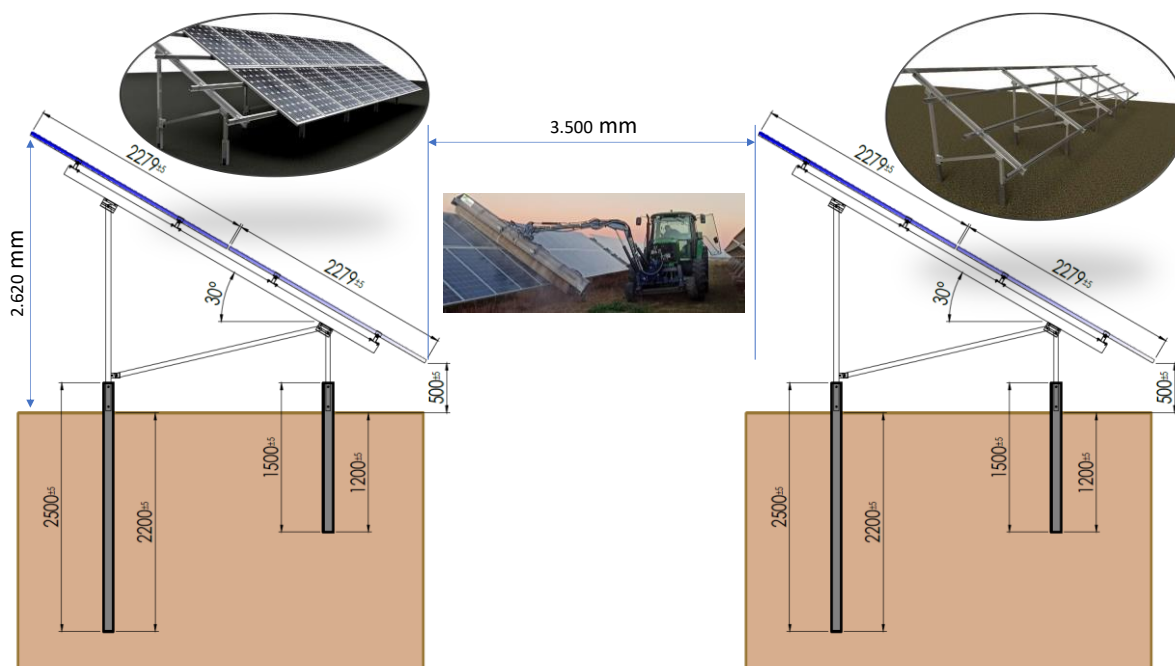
Disposició de les fileres d'estructures de suport dels panells a la planta fotovoltaica de Cas Jai.
